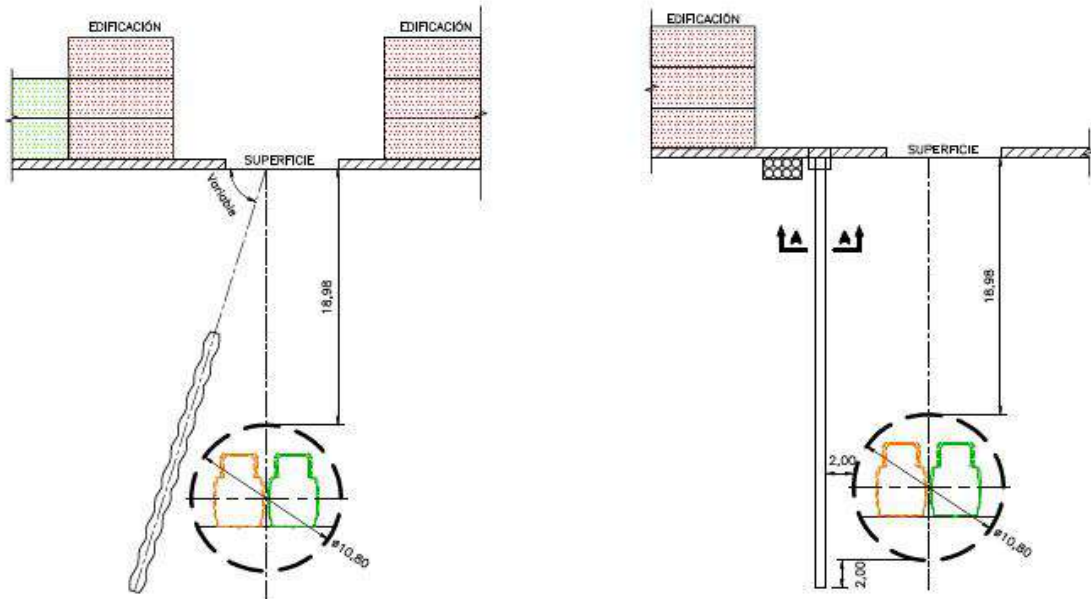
(Izquierda) Tratamiento D: Barreras de columnas de Jet Grouting. (Derecha) Tratamiento E: Barreras de pilotes de mortero.
